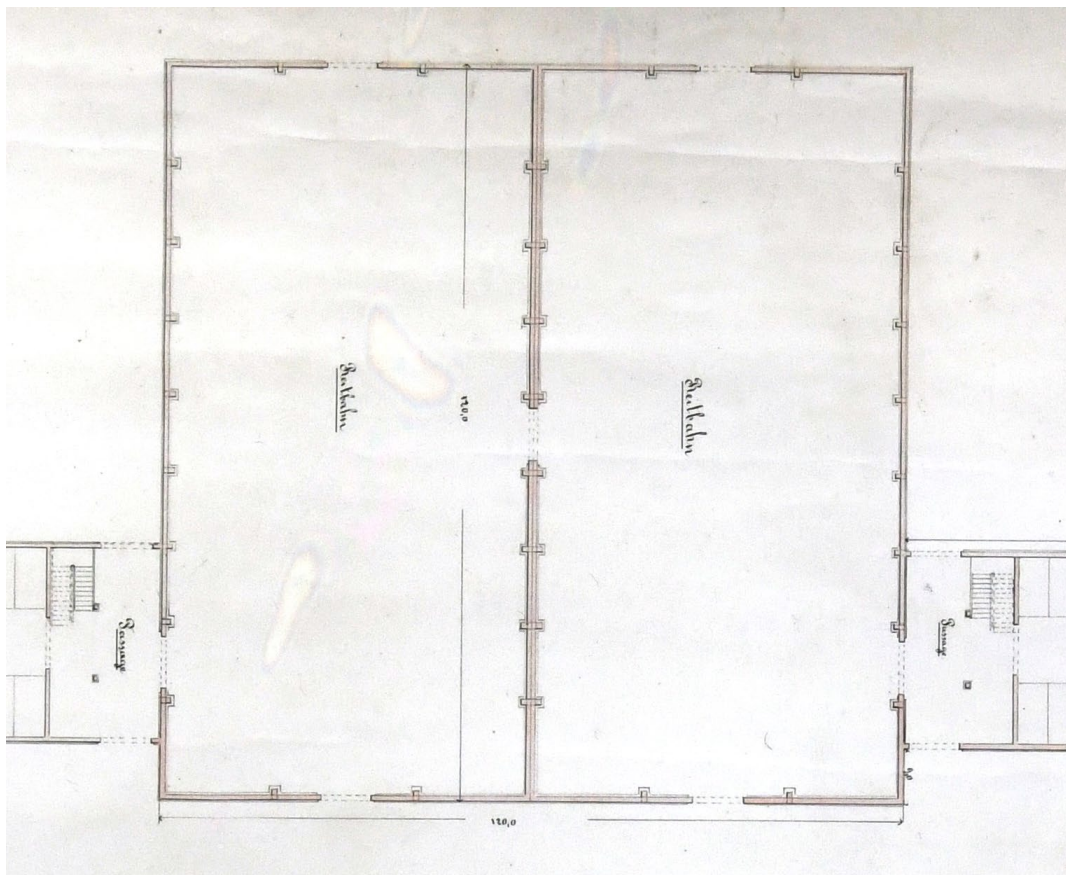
Grundriss der Doppelreithalle, Johann Joachim Brenner 1862 (Quelle: StATG, 2569).
